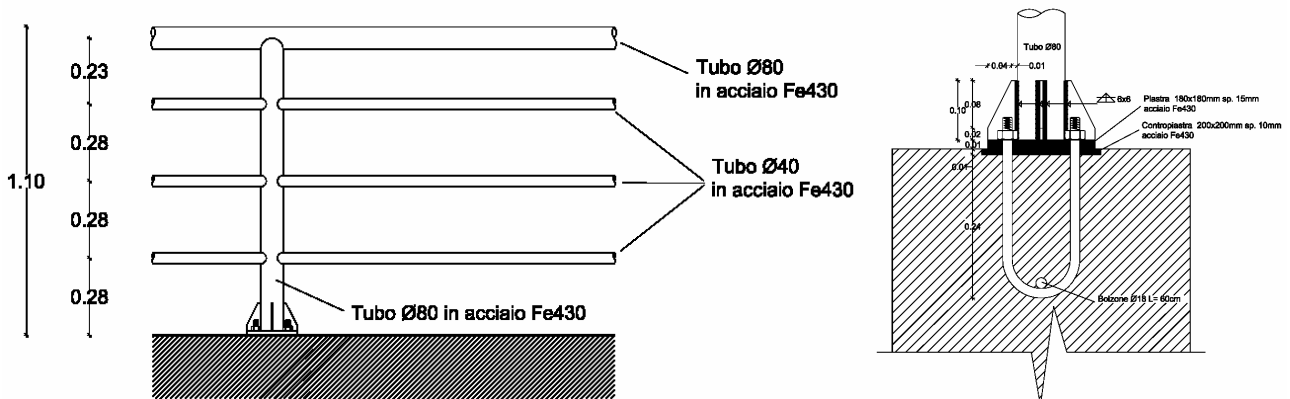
Particolari costruttivi del parapetto in acciaio: vista (a sinistra) e ancoraggio montante (a destra).
